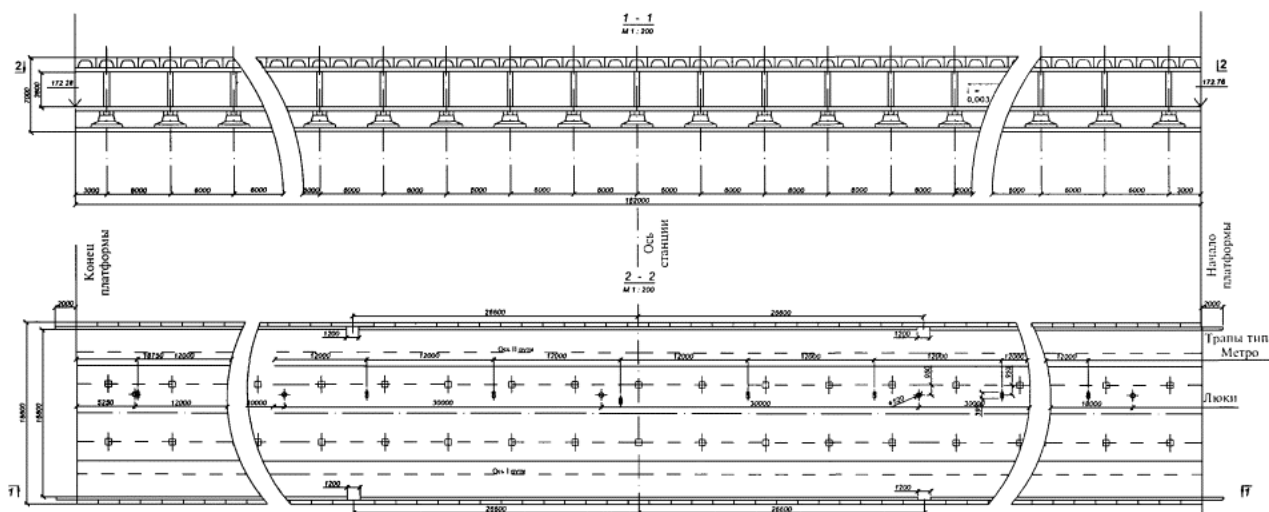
Схематический план и продольный разрез зала станции метрополитена мелкого заложения
